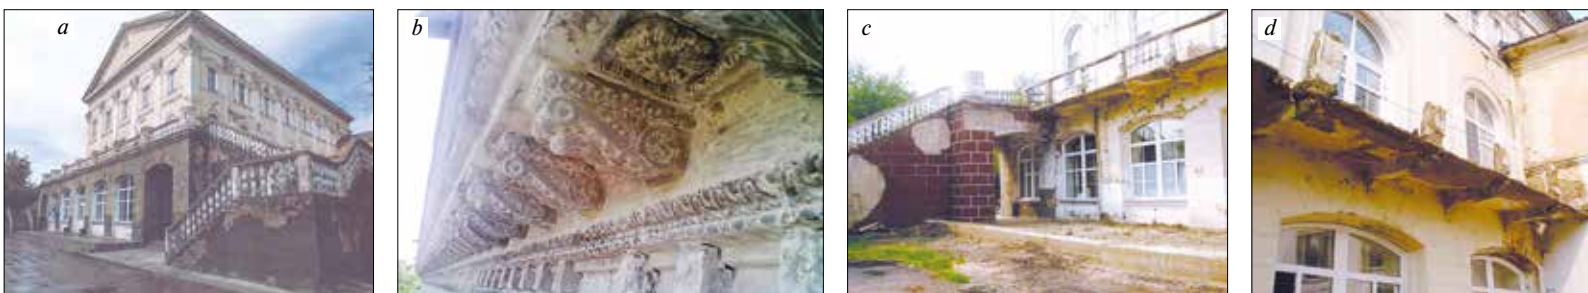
Главный фасад здания (a); внешний вид и состояние карниза (b); балконов (c); лестниц и декоративных элементов (d) главного корпуса до реконструкции
